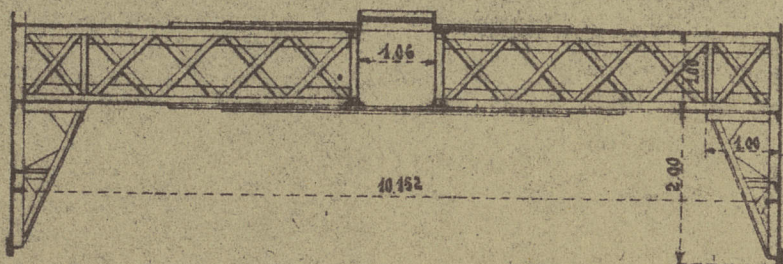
Coupe transversale du grand caisson de la cale sèche du Baire.
